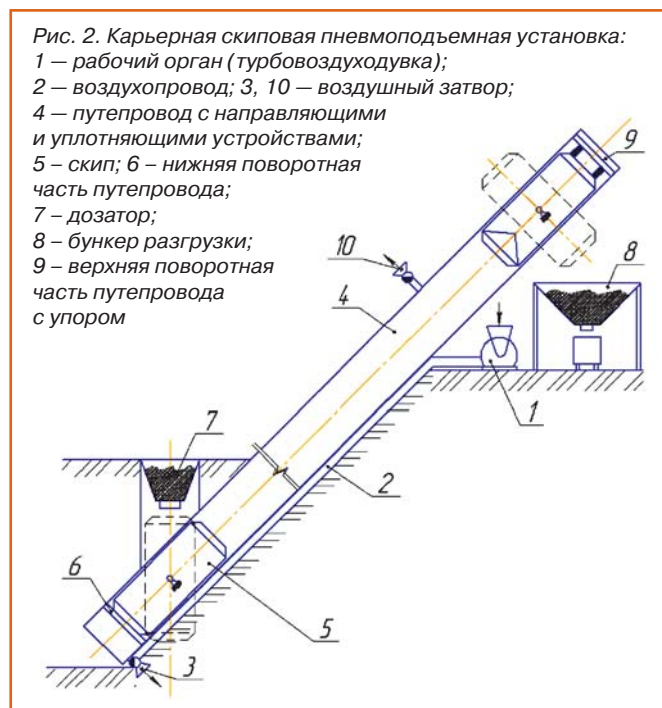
Карьерная скиповая пневмоподъемная установка: 1 — рабочий орган (турбовоздуходувка); 2 — воздухопровод; 3, 10 — воздушный затвор; 4 — путепровод с направляющими и уплотняющими устройствами; 5 — скип; 6 — нижняя поворотная часть путепровода; 7 — дозатор; 8 — бункер разгрузки; 9 — верхняя поворотная часть путепровода с упором
